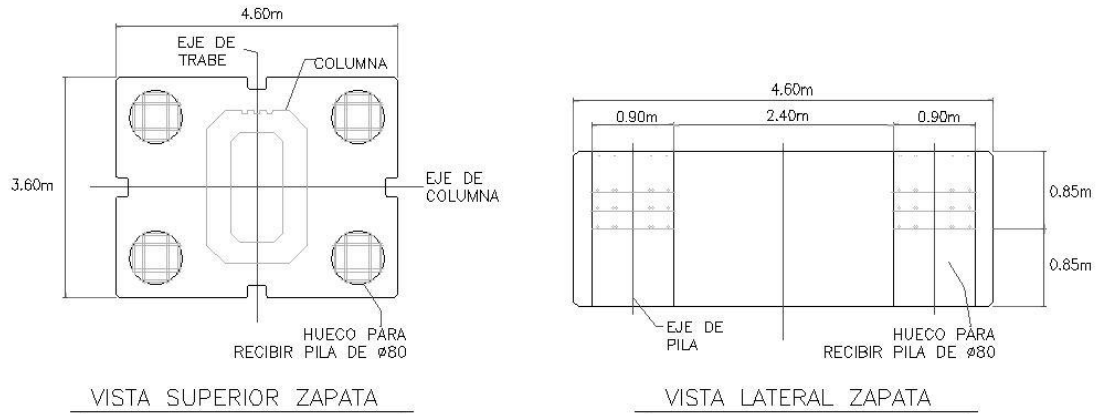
Geometría de las zapatas de las columnas instrumentadas
